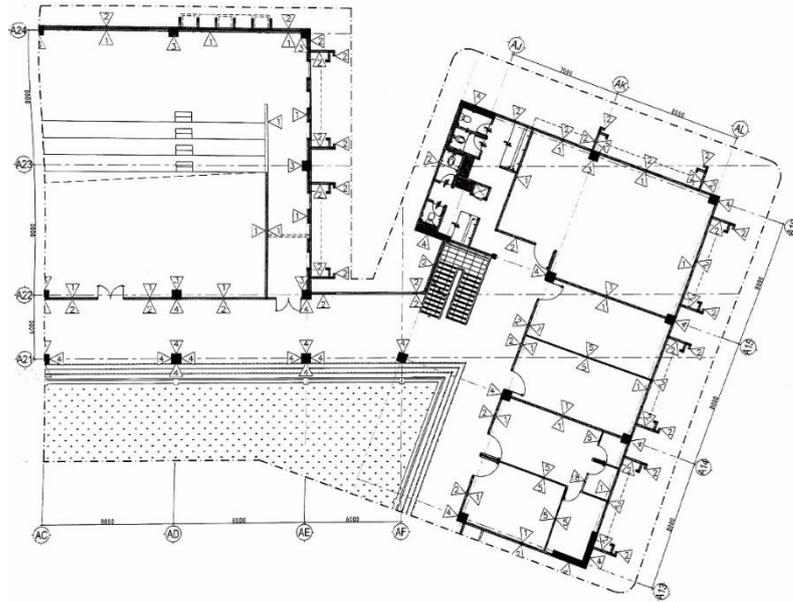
Parsial-1 denah rencana *finishing* dinding lantai 1
